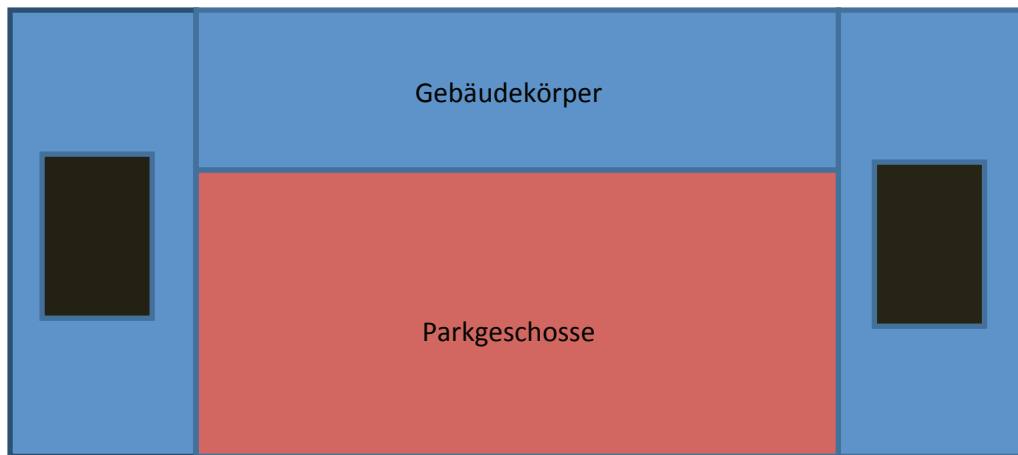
Schematischer Grundriss mit Parkgeschossen im Hof und partiellen Untergeschossen
